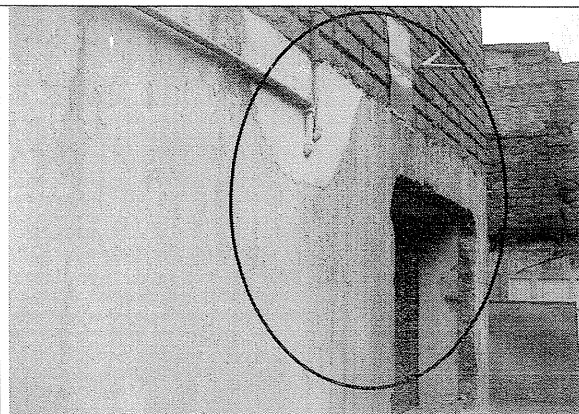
Fisuras en muros externos de la construcción de la zona posterior.
